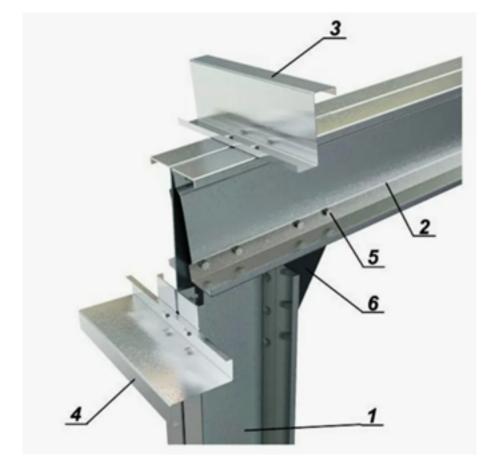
Узлы соединения стропильной балки и колонн ЛСТК:
